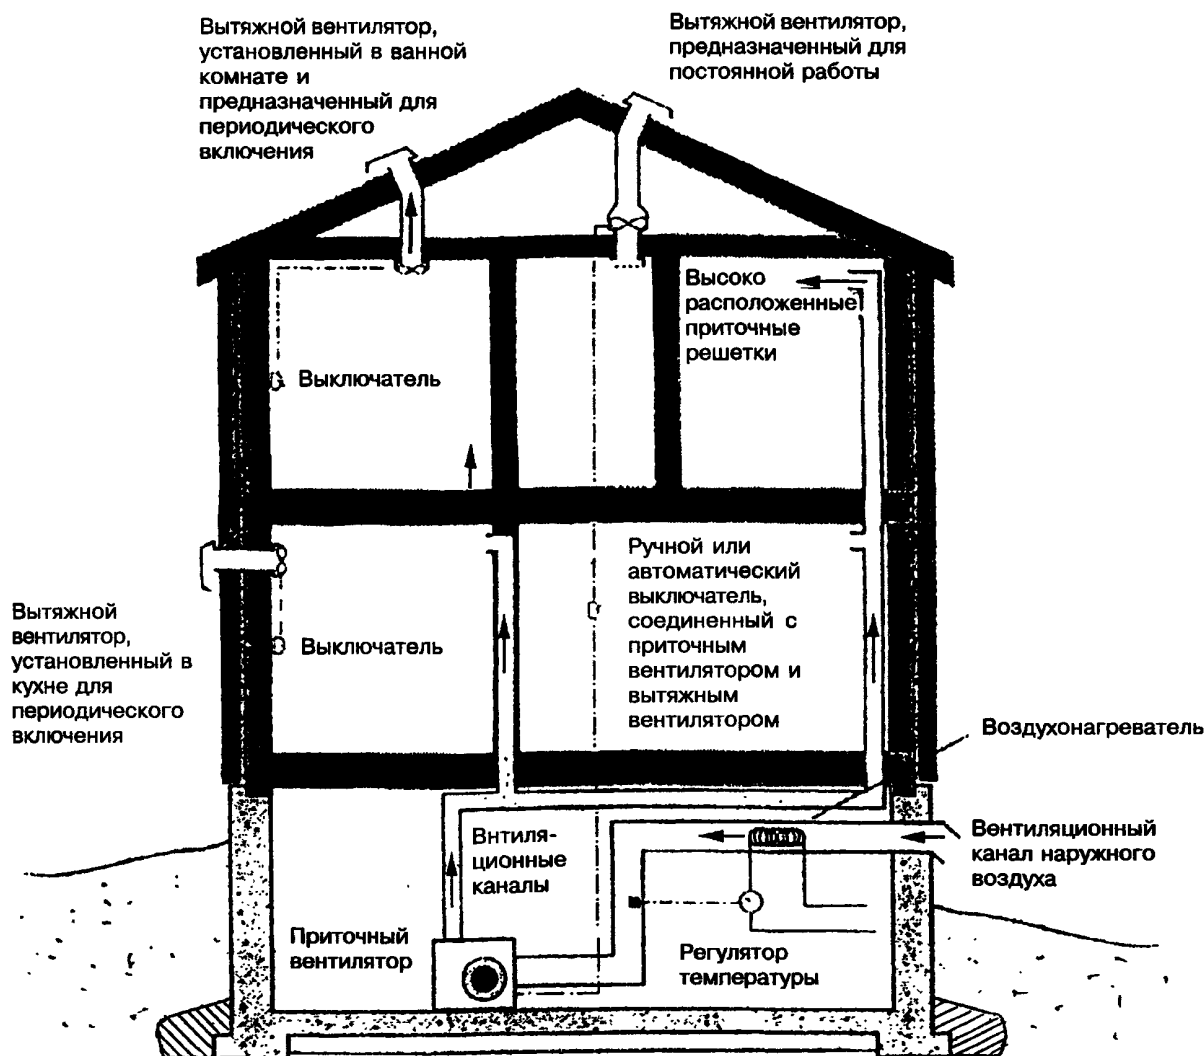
Система воздушного отопления с принудительной циркуляцией воздуха, совмещенная с системой механической вентиляции, не присоединенной к системе теплоснабжения
